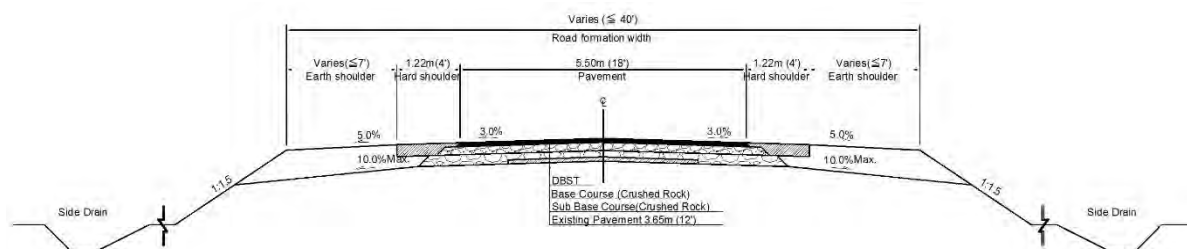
標準横断面図 (平地部/ MOC-05 : DBST 舗装道路 5.5m)
